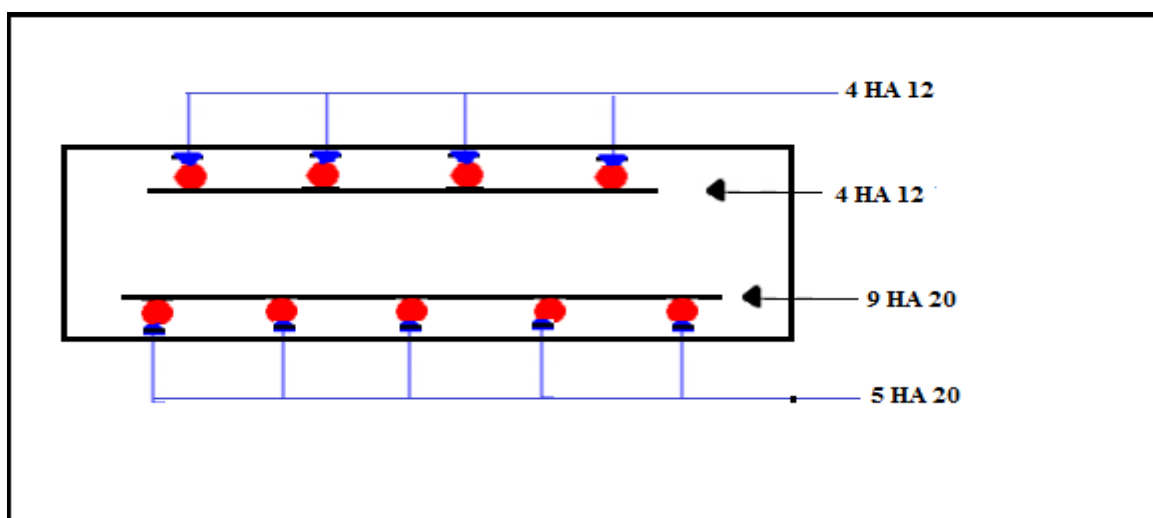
Ferrailage dans le sens Transversal (coupe B-B)
